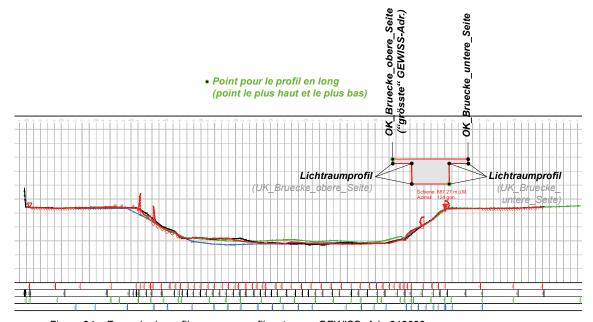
Exemple de profil en coupe, profil en travers GEWISS_Adr. 218628
